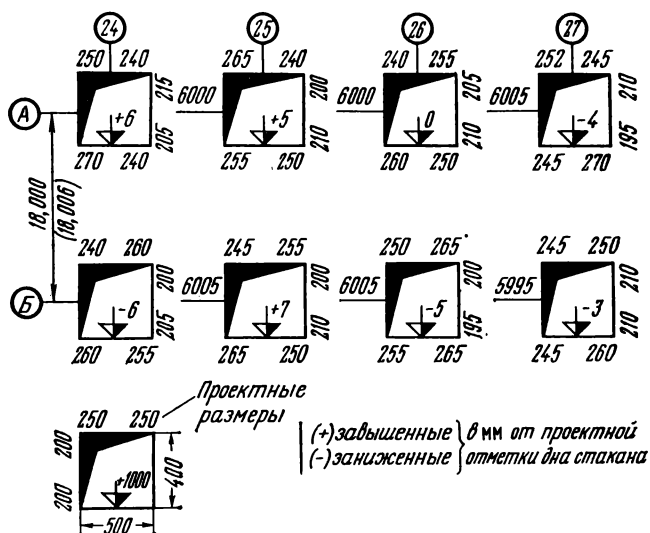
Исполнительная схема фундаментов-стаканов под железобетонные колонны
